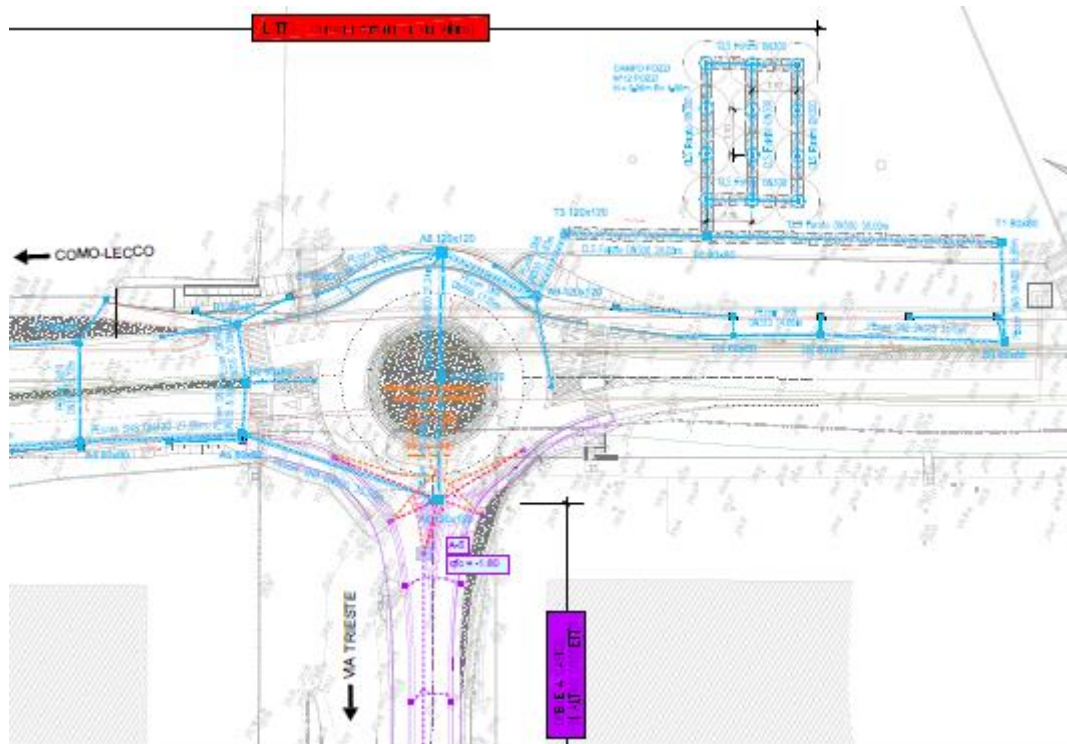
Rete di drenaggio e opere di compatibilizzazione con appalto del cavalcaviaferrovia.
